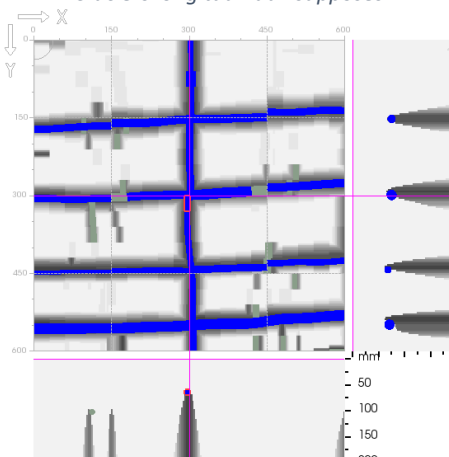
Poutre Pt02 – Travée 4 à mi-travée
